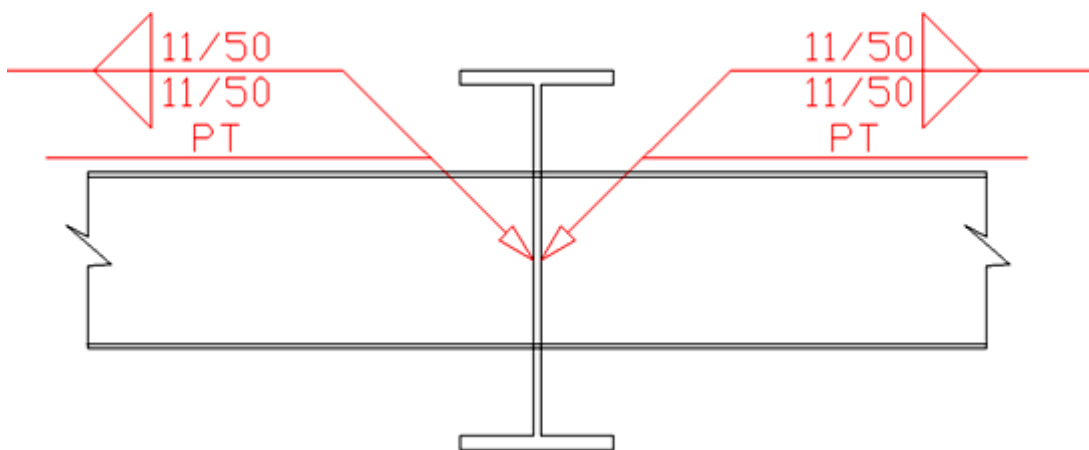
UNION DE VIGA IPN220-A/O A LA VIGA I
